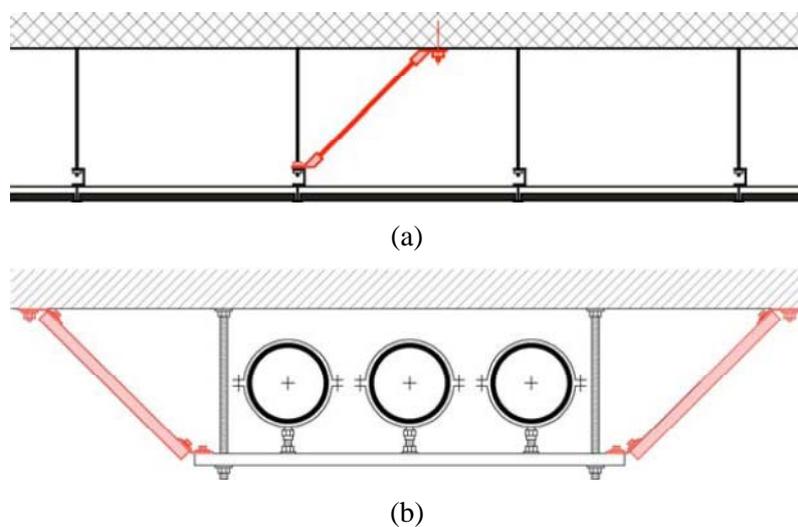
Fixation parasismique d'un chemin de conduites: a) contreventement longitudinal et b) contreventement transversal (Marxer et al. 2003).
